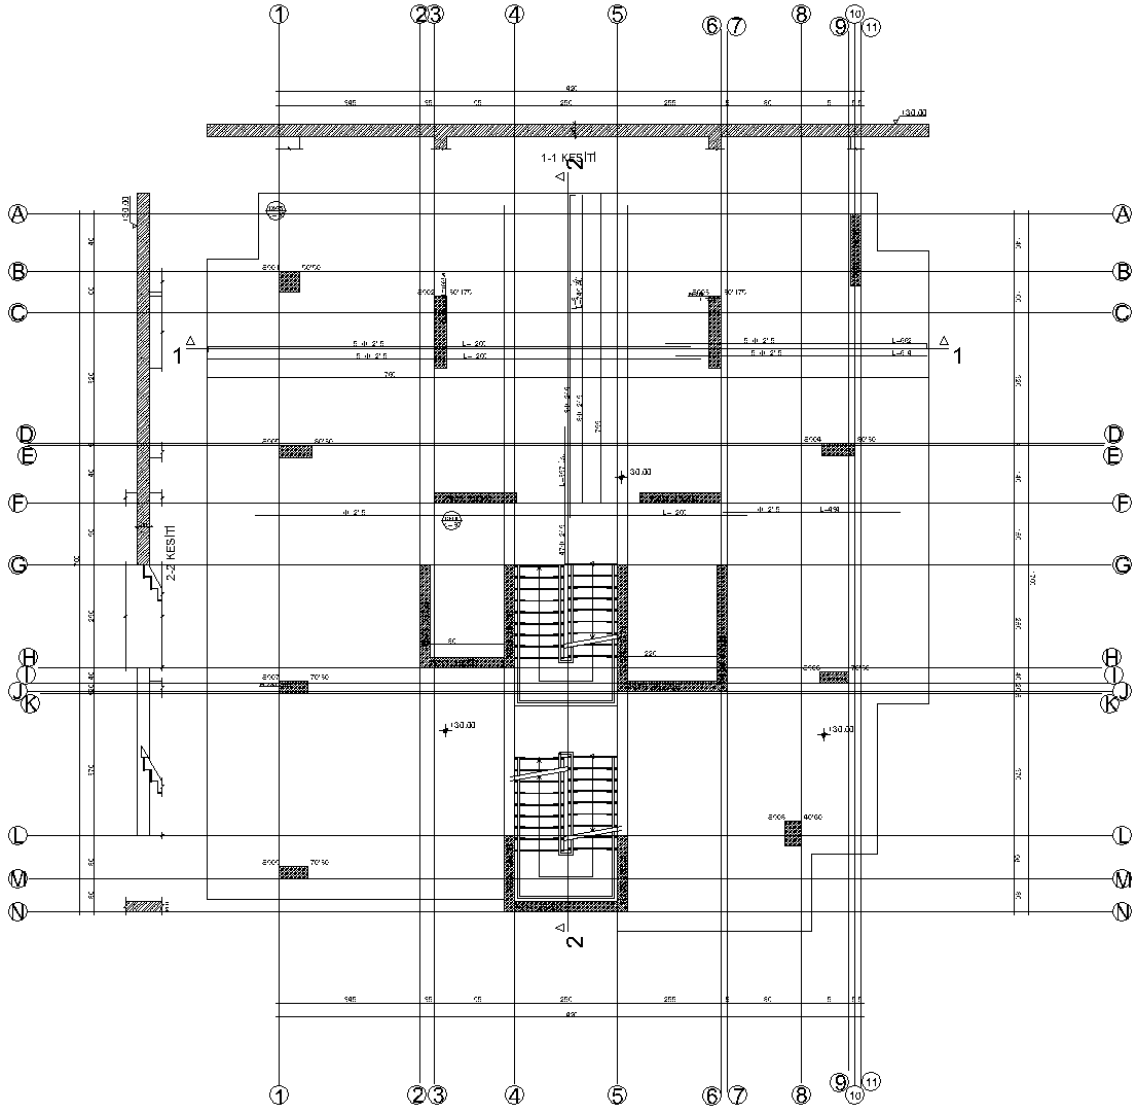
Kaset döşemeye ait bodrum kat kalıp planı
